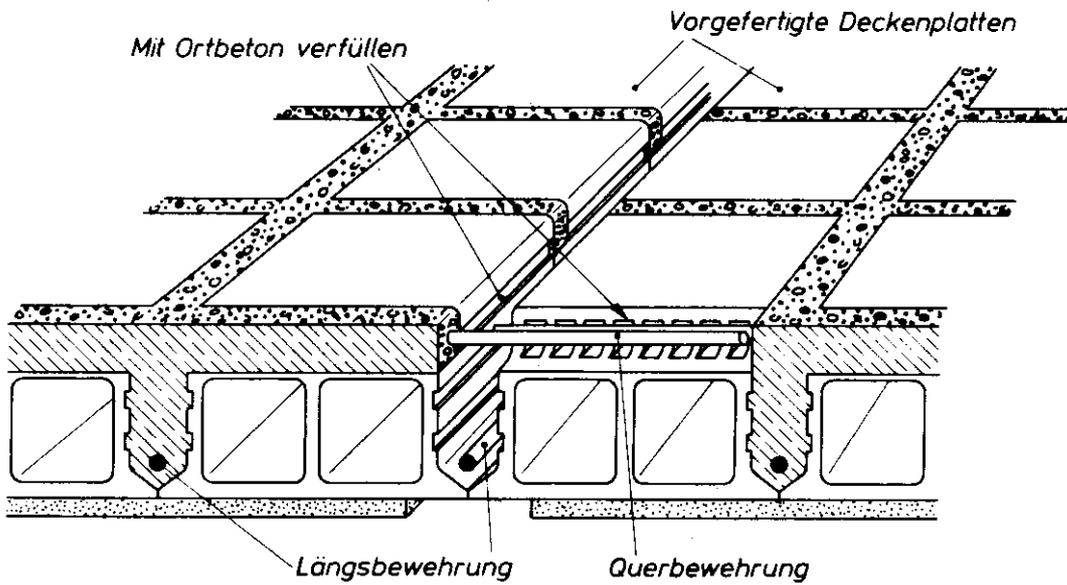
Verbindung zweier Deckenplatten aus Ziegeln mit teilvermörtelbaren Stoßfugen nach DIN 4159; Überdeckungsstoß der Querbewehrung
